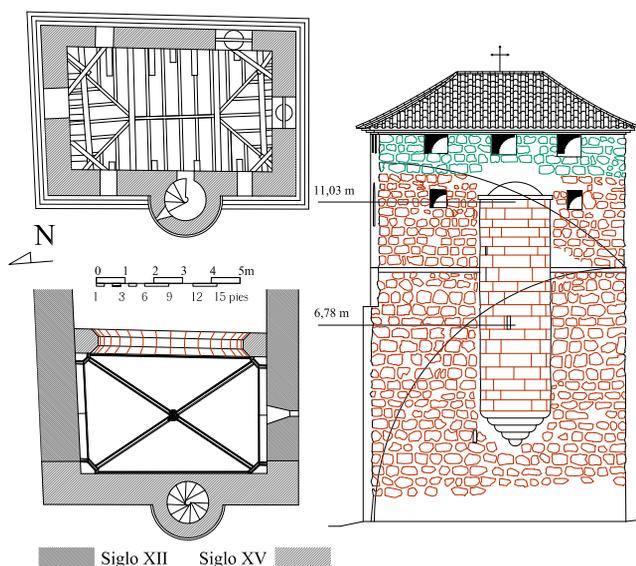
Alzado y plantas de la torre de Moradillo de Roa, donde puede observarse la proporción cuadrada del cuerpo de la torre y la dupla de las plantas, así como las partes del muro románico aprovechadas como soporte de la torre gótica.
